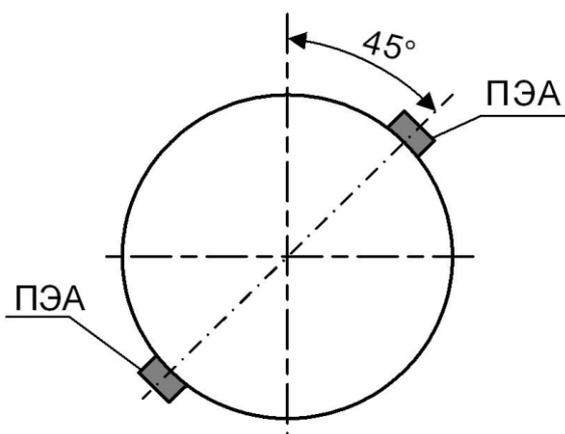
Рекомендуемое положение ПЭА на трубопроводе относительно вертикали.
